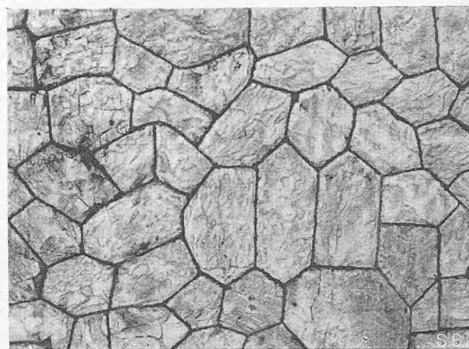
Missverständenes Zyklopenmauerwerk aus Lägerkalk mit lagerhafter Struktur
